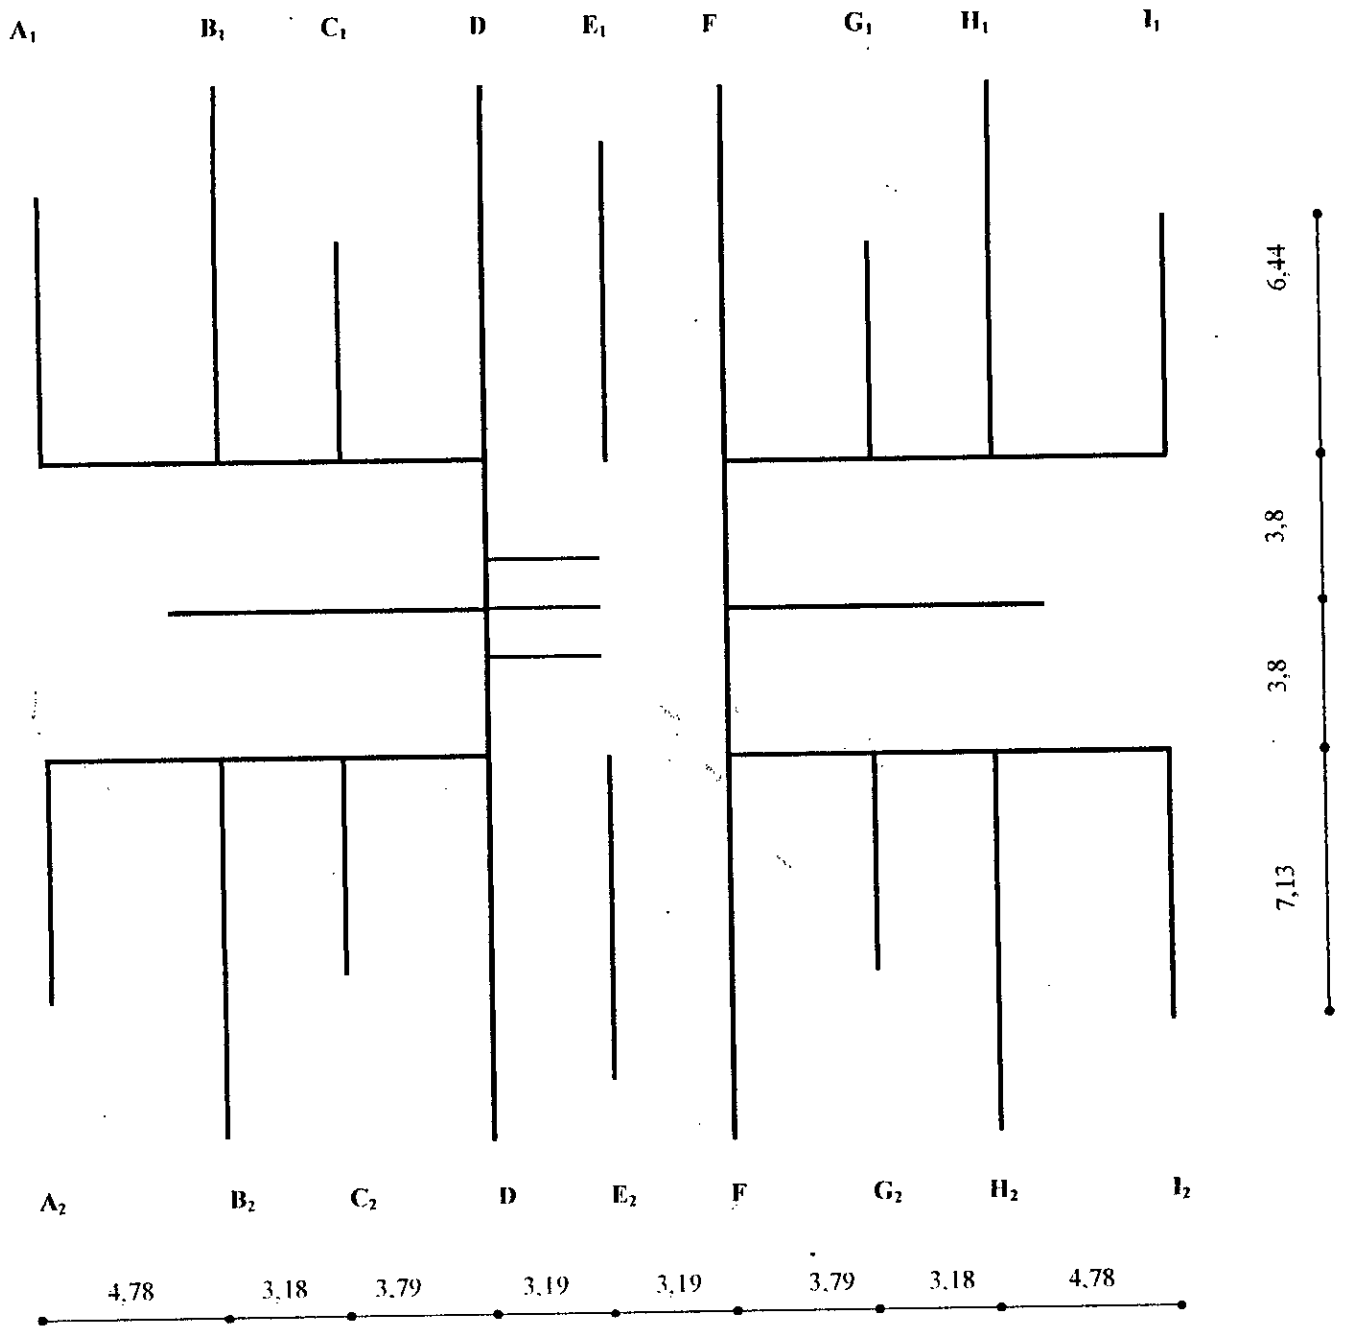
VUE EN PLAN DE NIVEAU 14
